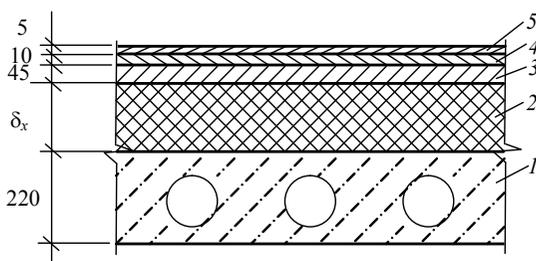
Вариант 1-й конструкции перекрытия над неотапливаемым подвалом:
